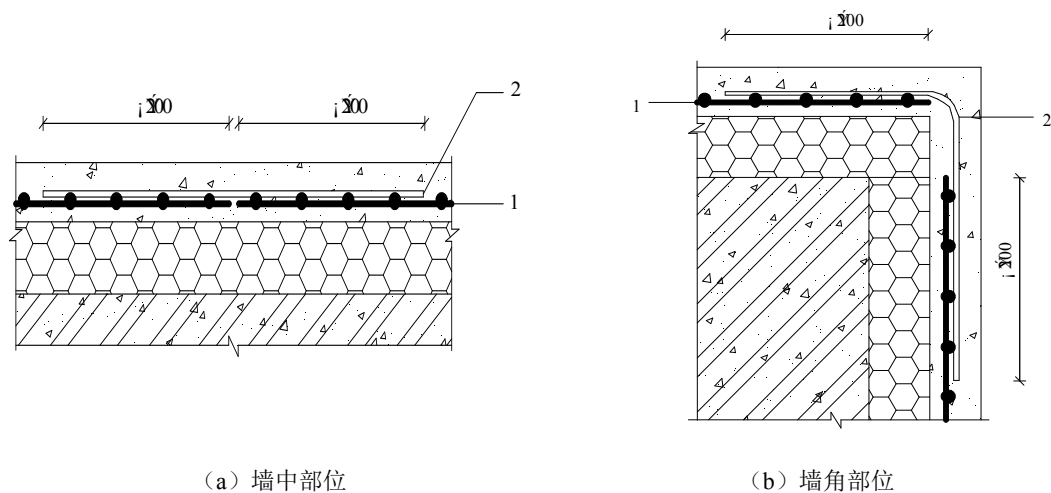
构造层钢筋焊网墙身搭接
